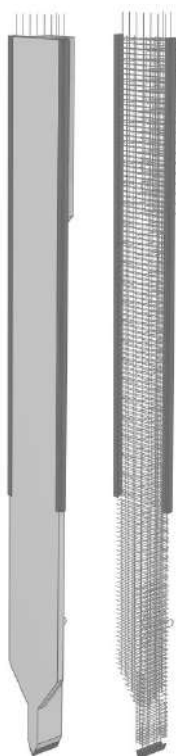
Модель таврового железобетонного шпунта ШТВ 15.7 и его каркаса
